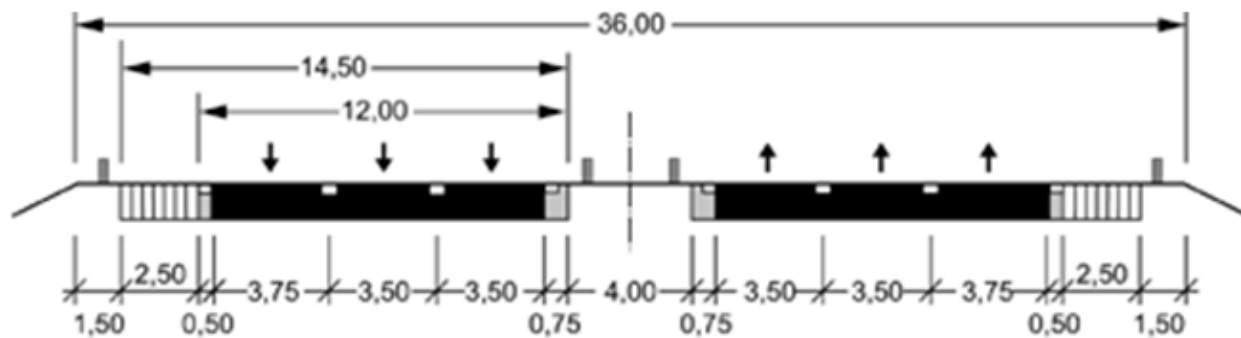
Regelquerschnitt für Autobahnen der EKA 1 (Abmessungen in [m]) ¶
